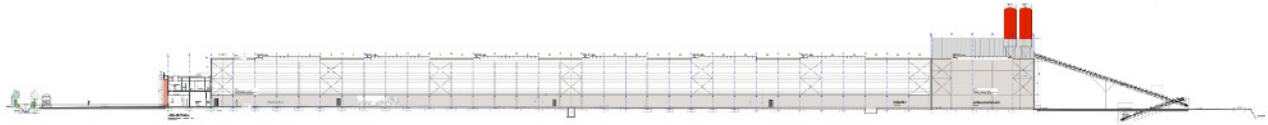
PLAN 18 Langssnede doorheen de fabriek. © AP/ART
